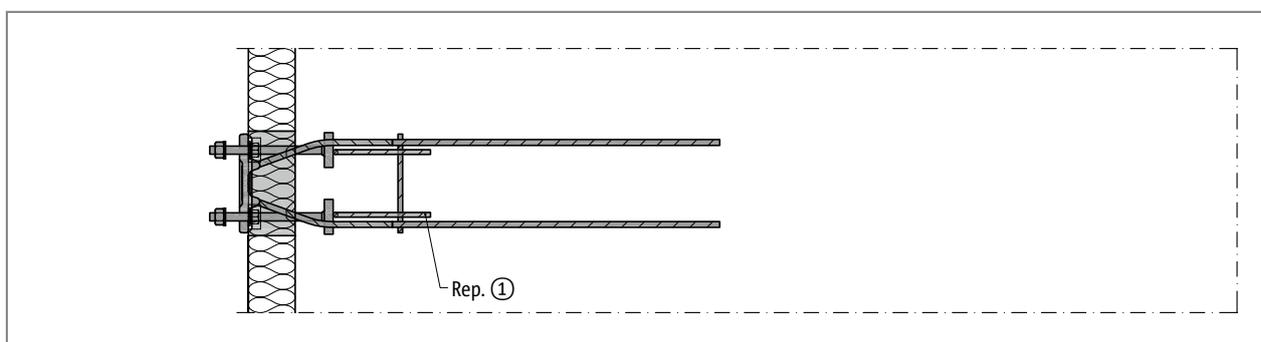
Schöck Isokorb® T type SQ : renforcement sur site, plan de base
